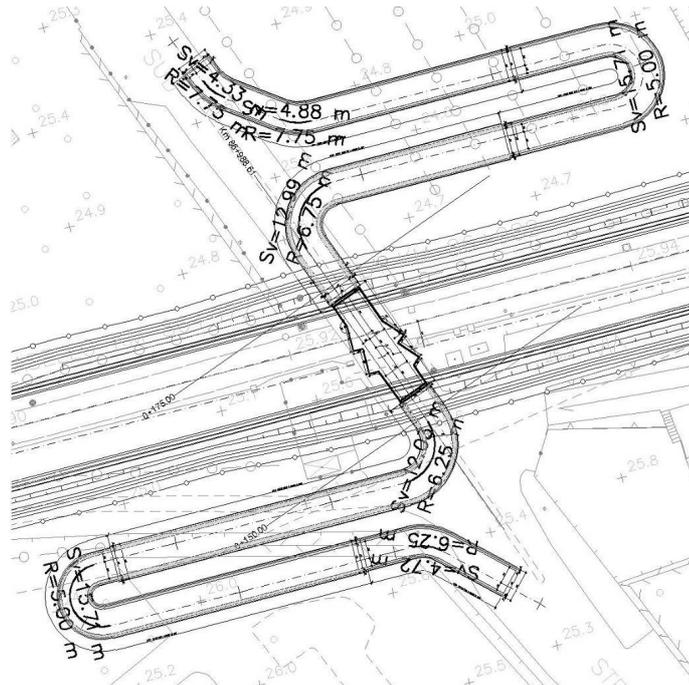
inquadramento planimetrico pista ciclo-pedonale
